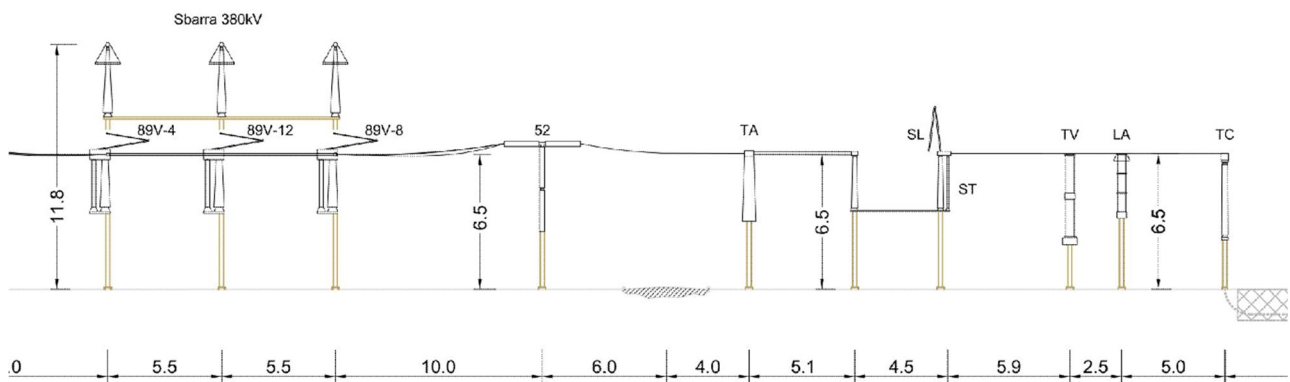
Stazione Sud – planimetria sezione 380 kV
